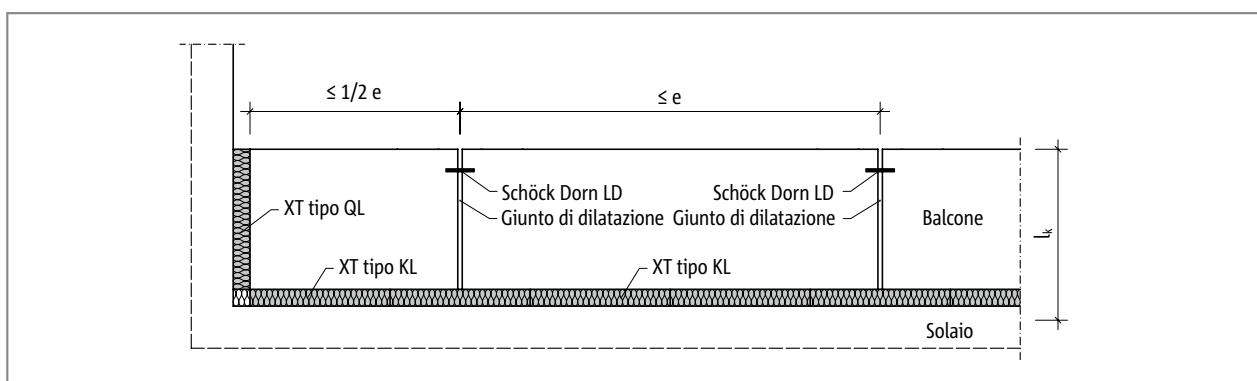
Schöck Isokorb® XT tipo K: disposizione dei giunti di dilatazione
